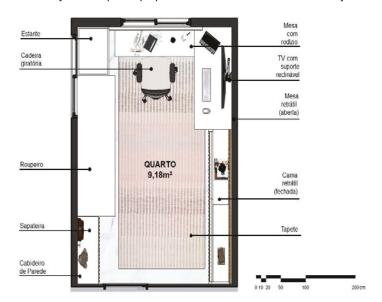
Planta baixa Layout 01 - quarto: proposta de mesa com rodízio debaixo da janela.
